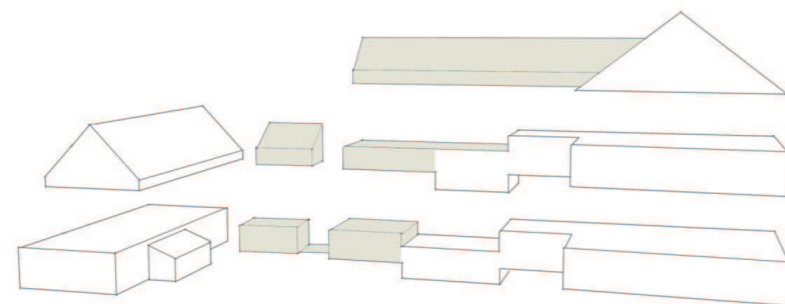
Darstellung der Baukörper, der Raum der Intervention ist farblich gekennzeichnet
